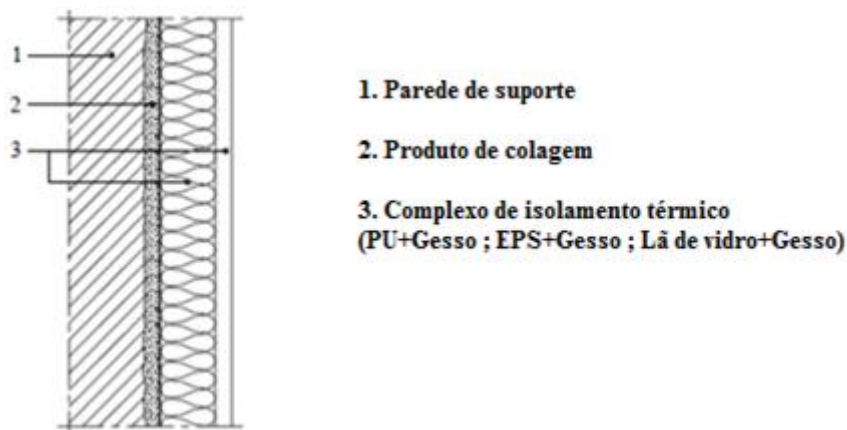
Sistema construtivo de isolamento de parede de fachada pelo interior
